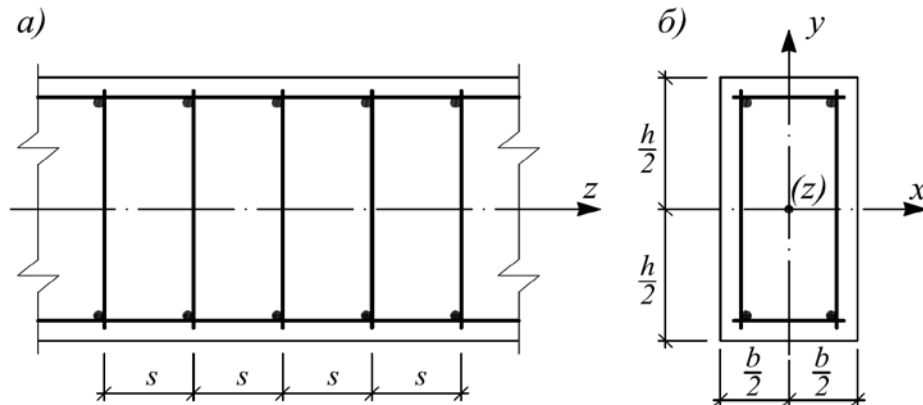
Фрагмент поздовжнього розрізу (а) та поперечного перерізу (б) залізобетонного стержня з прив'язкою осей до його бокових граней
